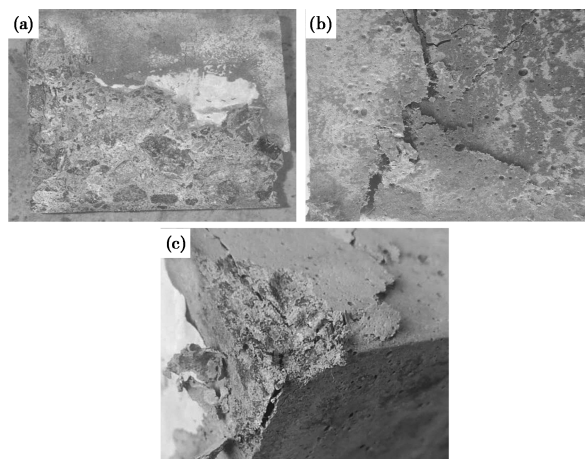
基准混凝土试件及纤维长度不同的 PVA 纤维混凝土试件的抗压效果图
